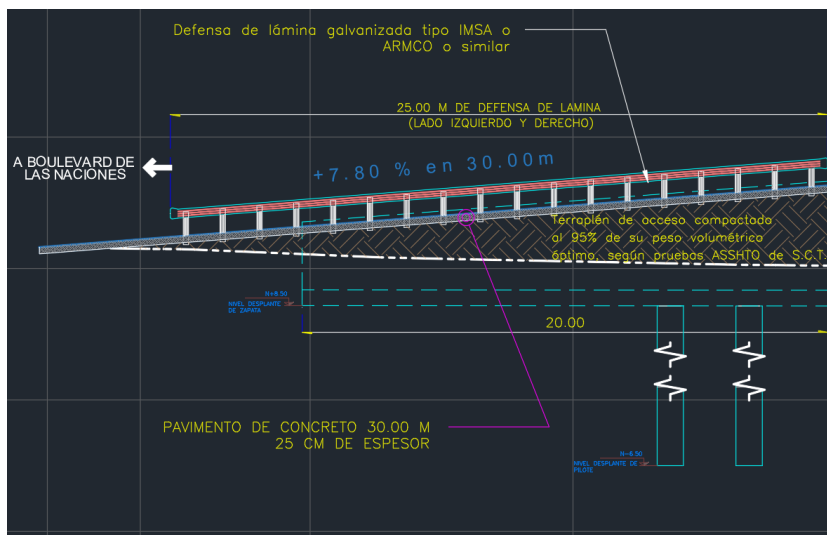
Perfil de la primera rampa de acceso del puente vehicular La Marquesita
